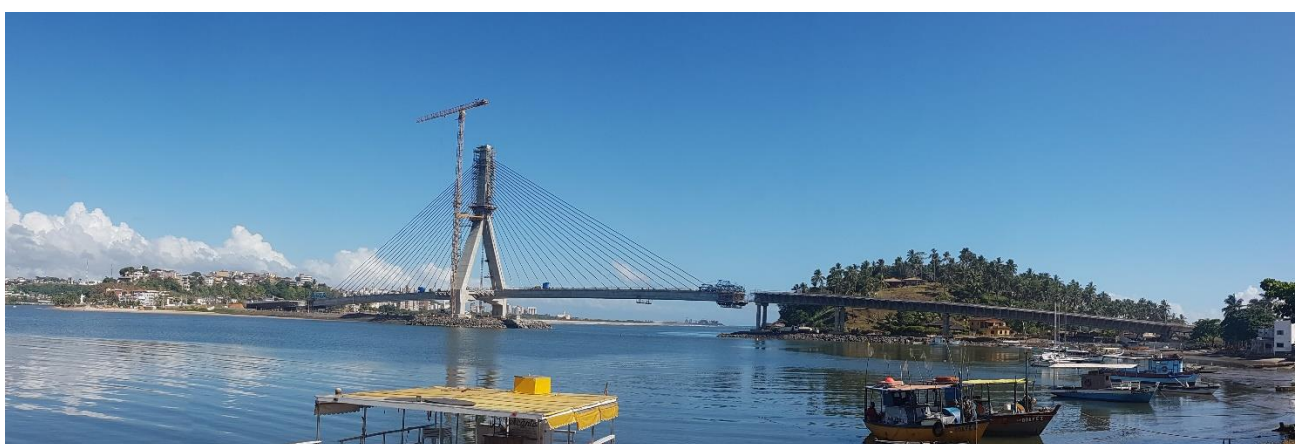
Foto de janeiro/2018 início da construção do pilar central
